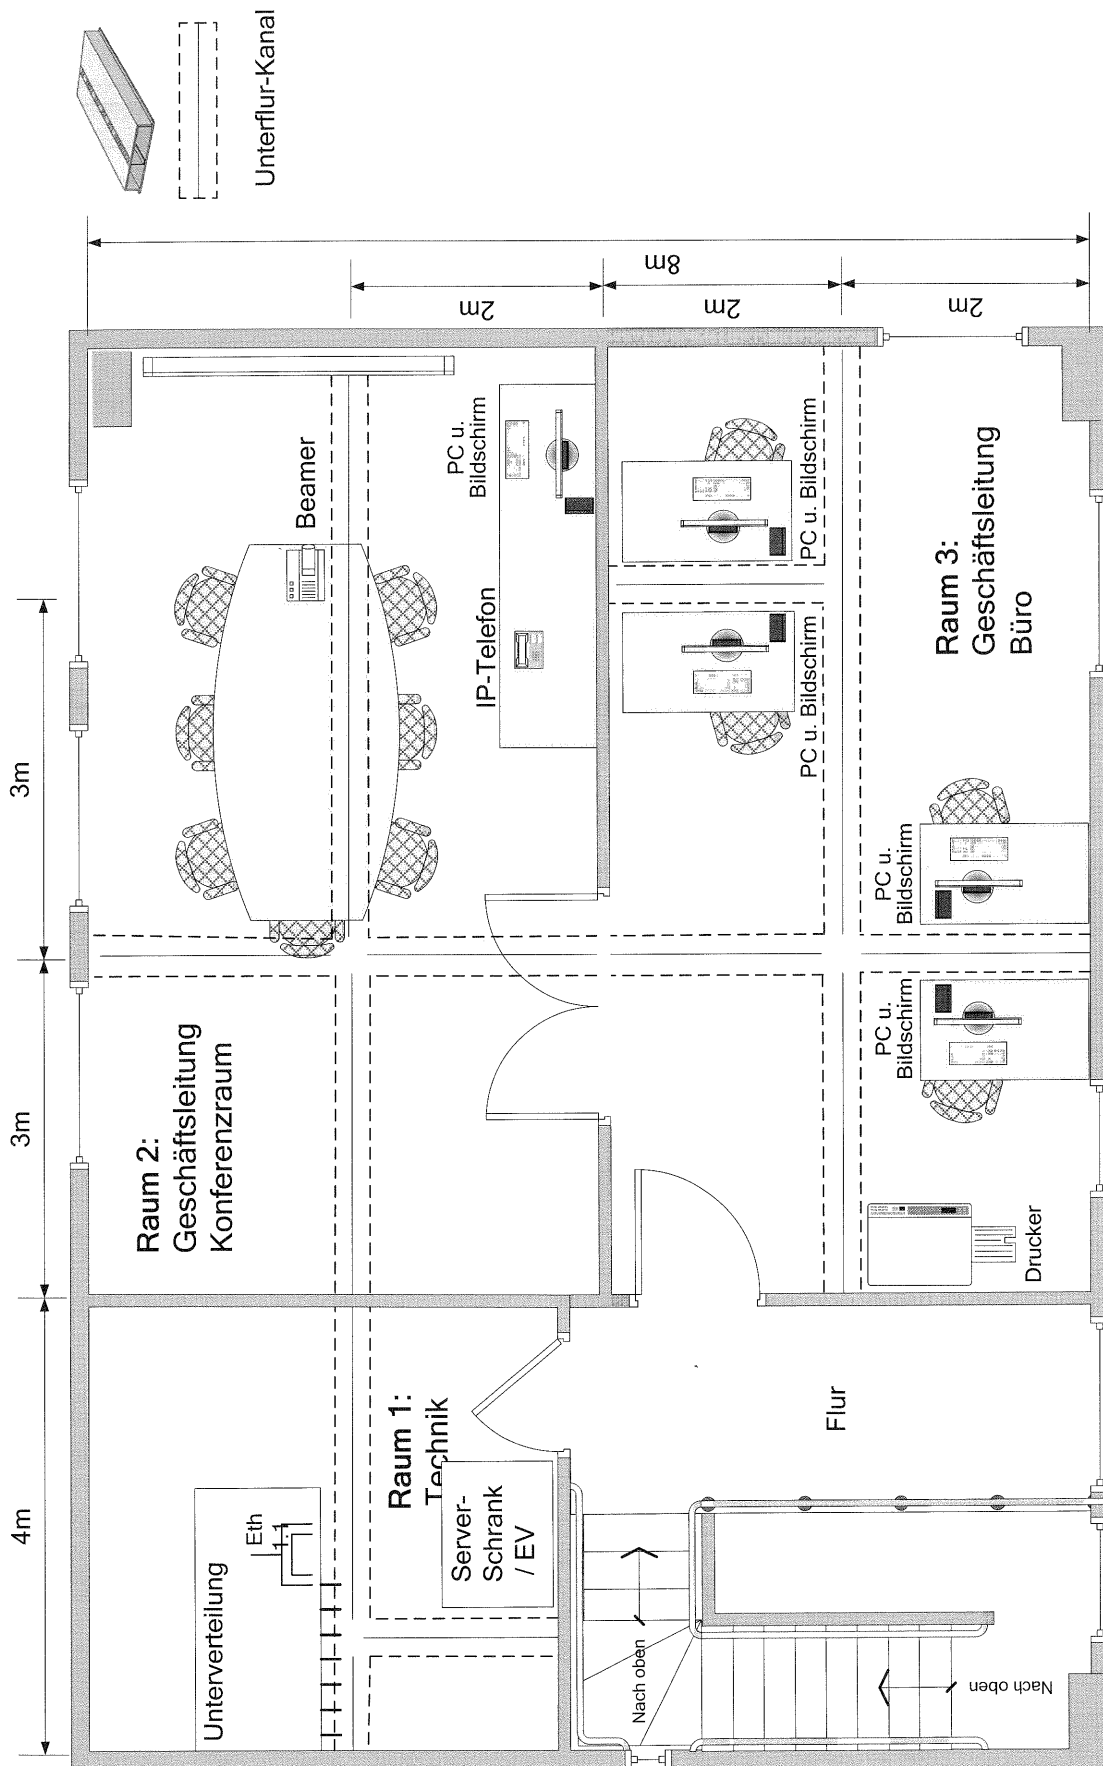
Handlungsschritt: Grundriss Gebäude I, 1. Etage
